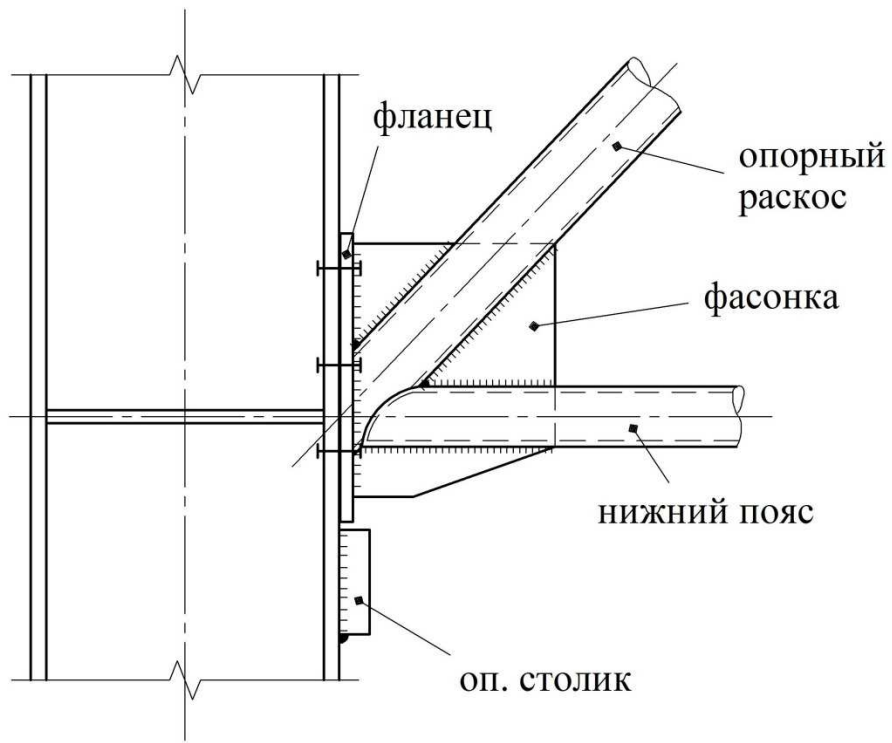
Вариант опорного узла стропильной фермы-ригеля рамы из круглых труб
